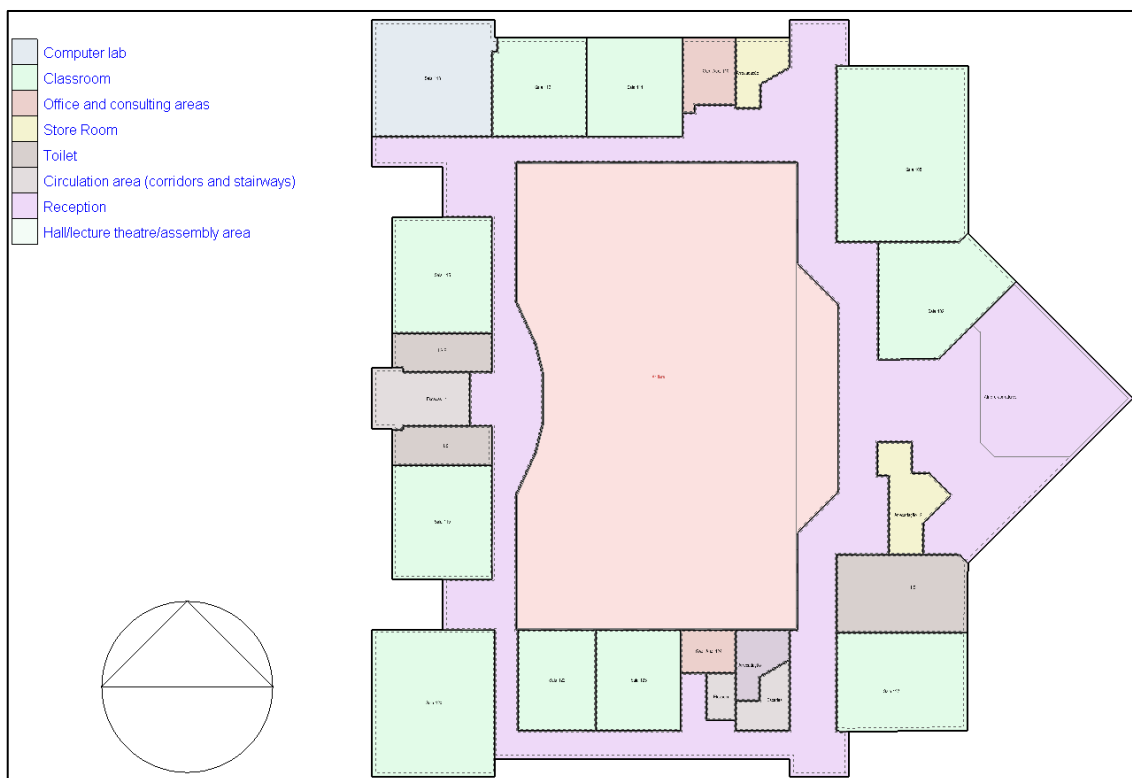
Planta do piso 0 do modelo com as zonas térmicas identificadas
